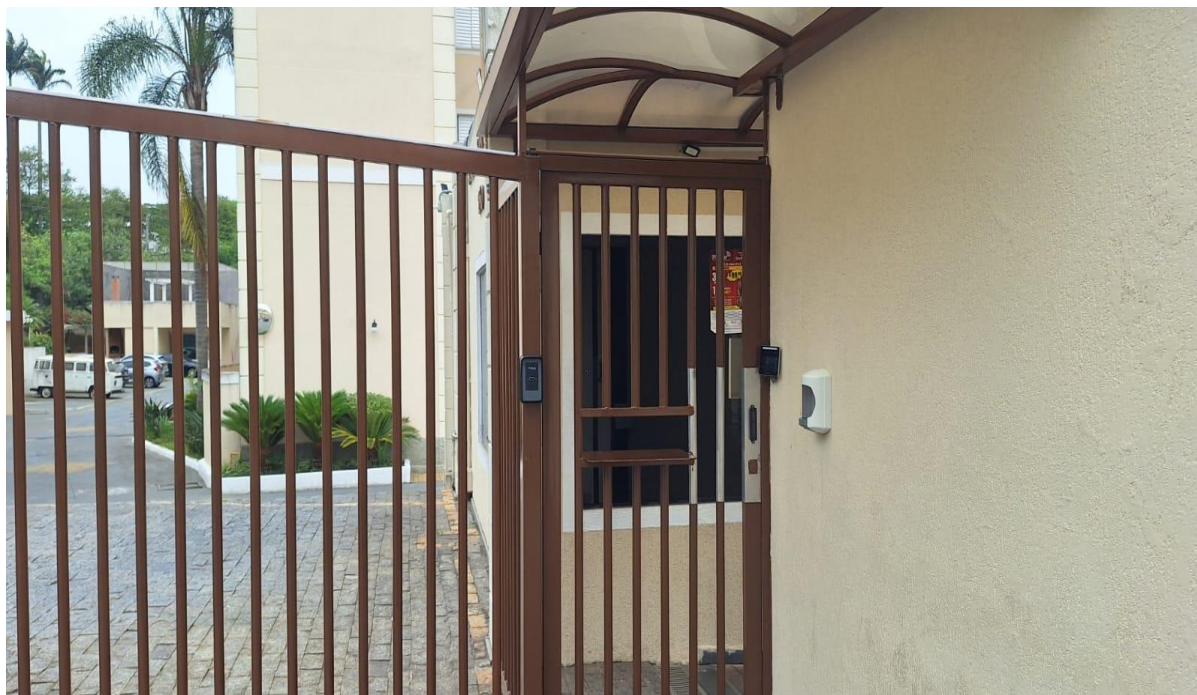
Portão de entrada de pedestres com leitura facial (cadastrados)
